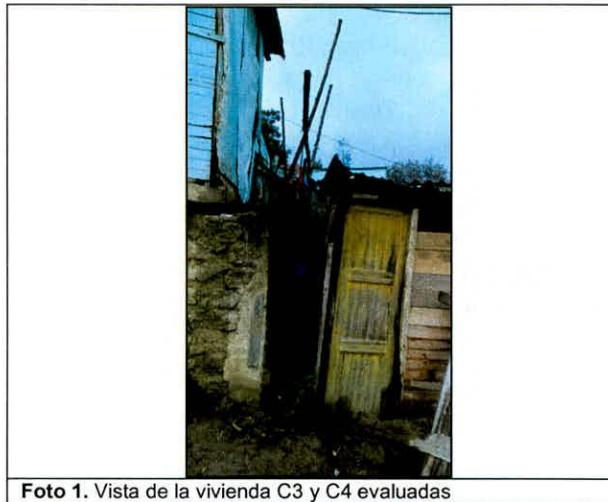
Vista de la vivienda C3 y C4 evaluadas
